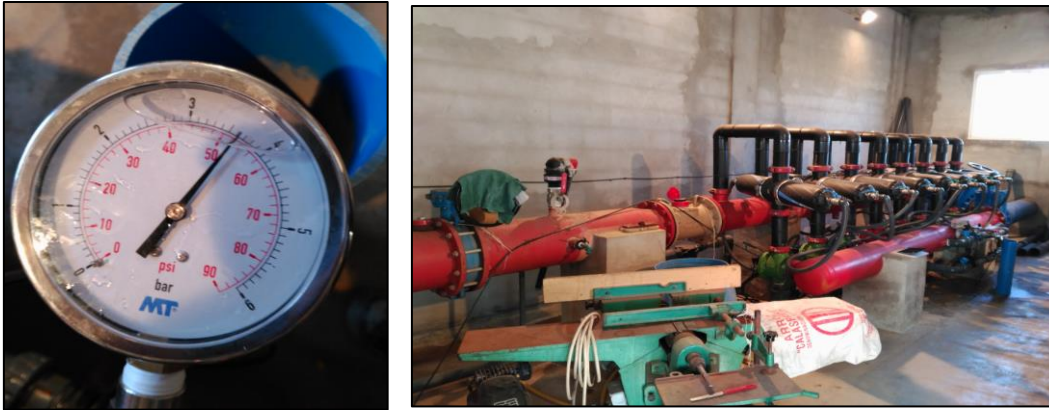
Detalle elementos de sistema hidráulico; manómetro, transductor de presión, caudalímetro y batería de filtros
